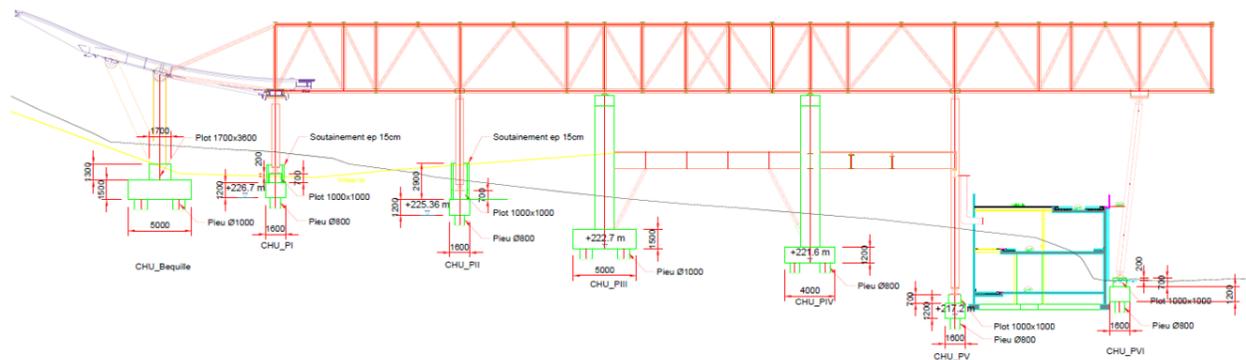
Plan des fondations de la station CHU (source Groupement POMA, 2016-2018)
